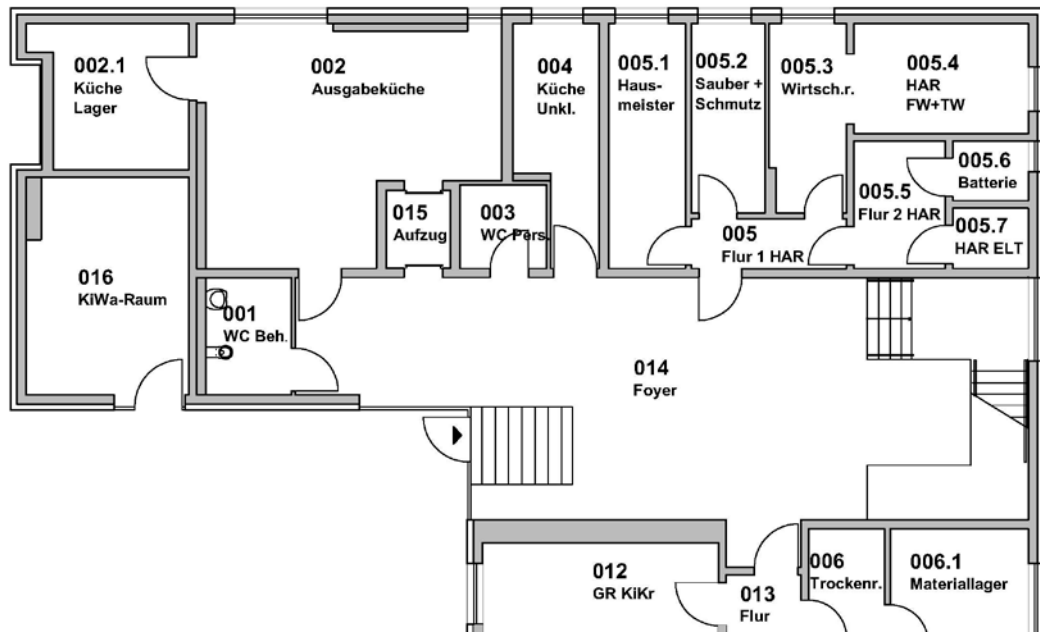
Grundriss zur Raumnummerierung
